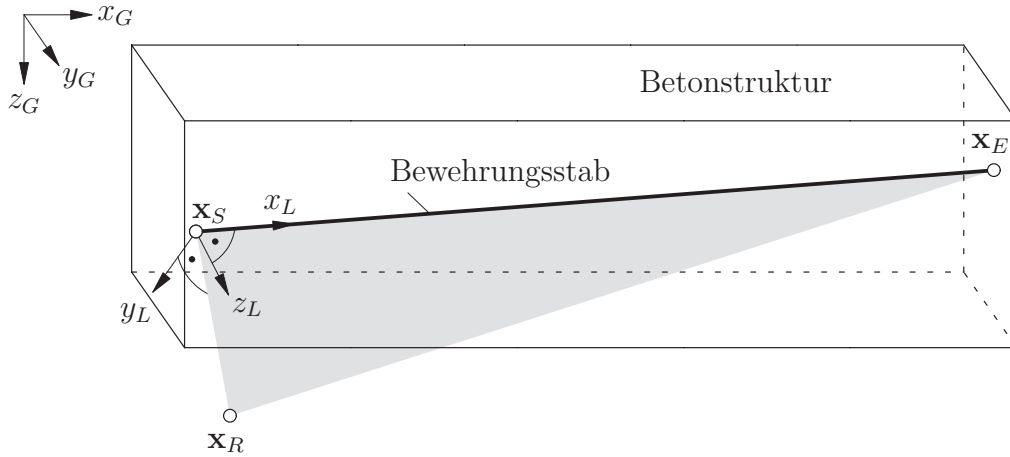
Lage eines Bewehrungsstabs in der Betonstruktur
